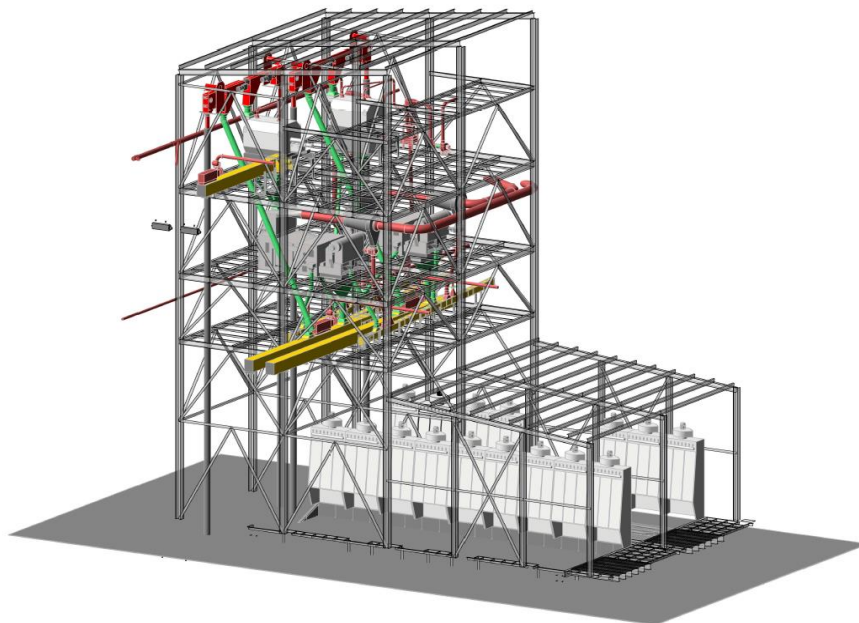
Общий вид конструкции стального каркаса и расположение оборудования
